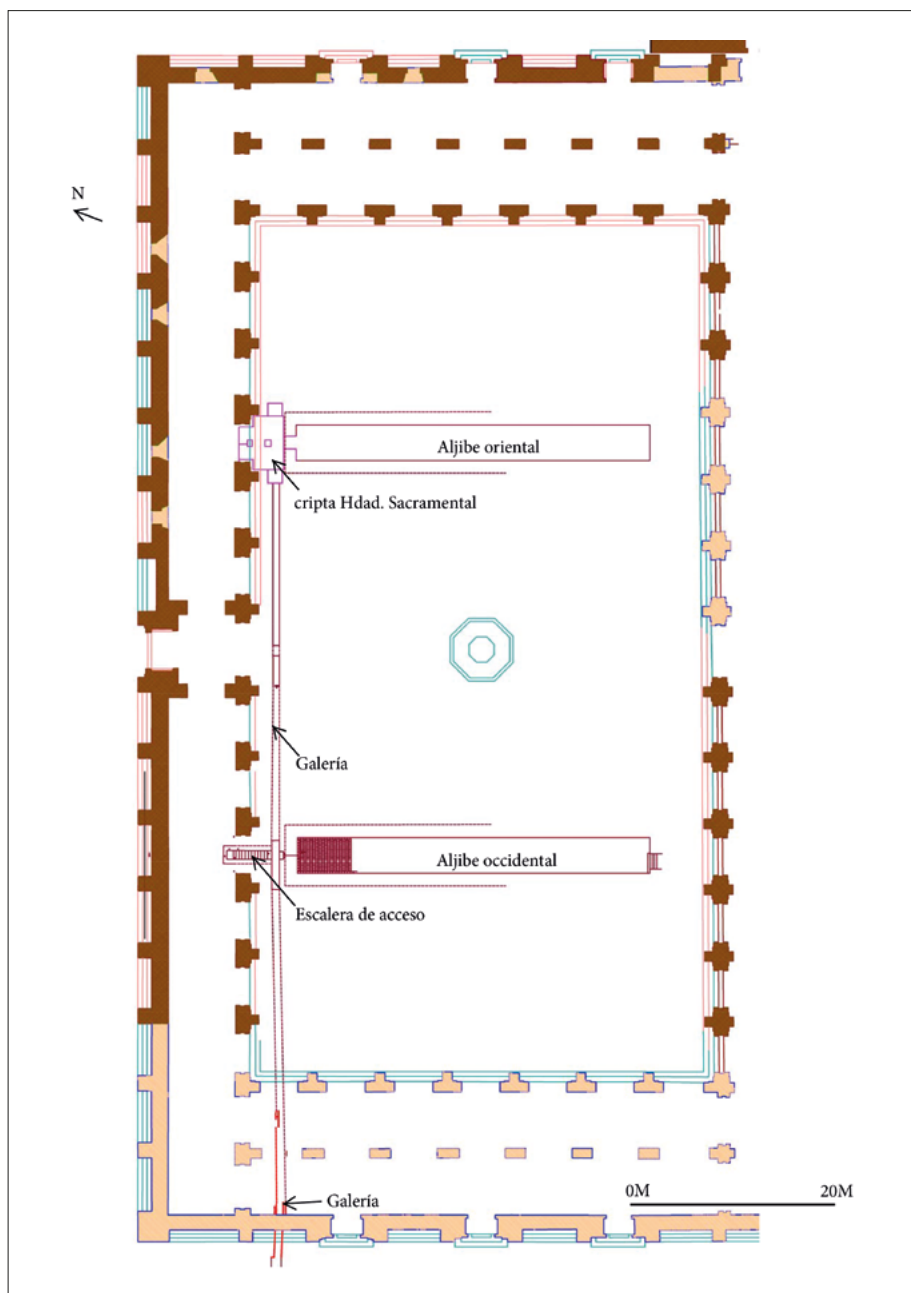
Planta general de los aljibes existentes y trazado de la galería.
